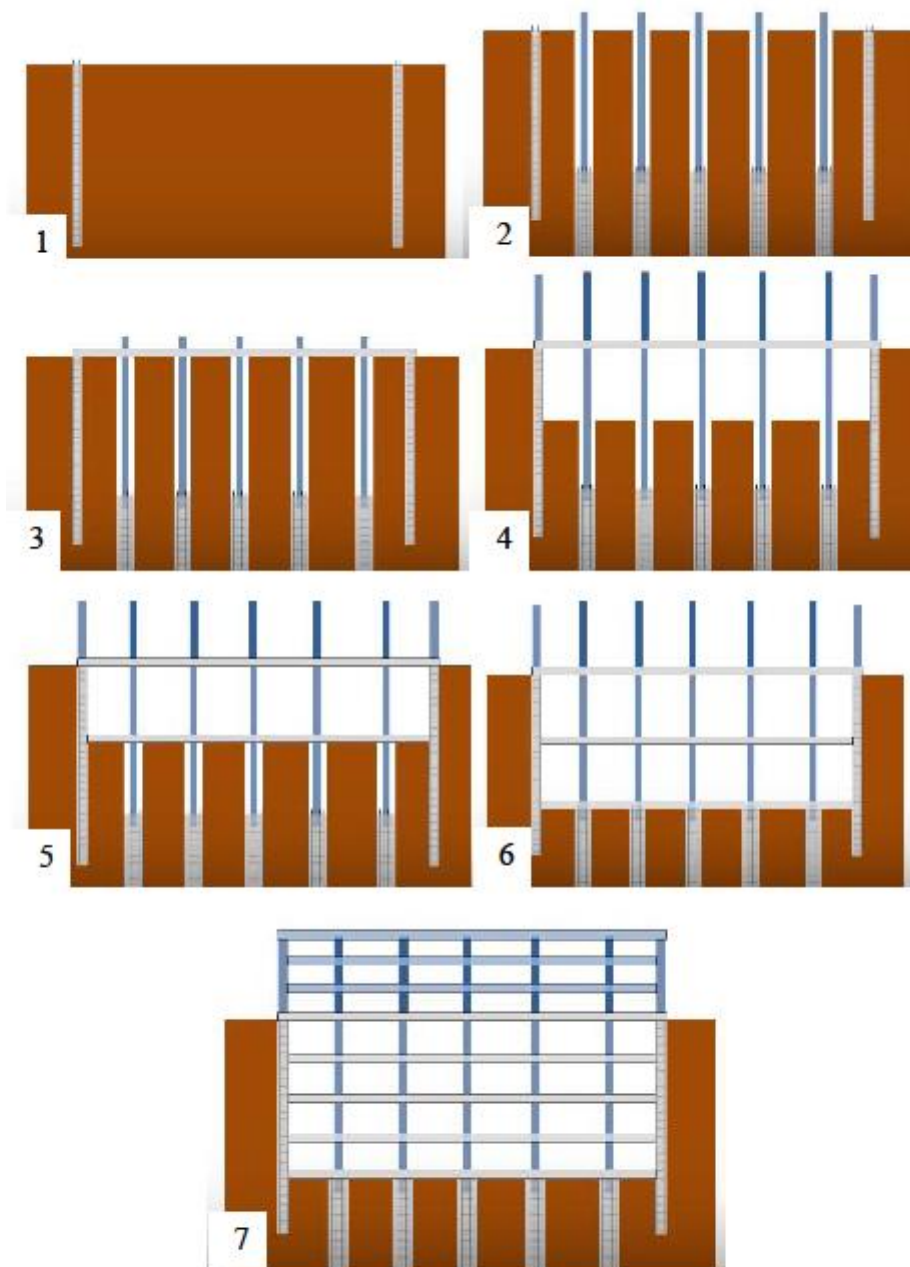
Пример последовательности возведения здания методом «сверху-вниз». 1- устройство «стены в грунте», 2 – производство свай и подземных частей колонн, 3 – устройство перекрытия на уровне земли, 4 – разработка первого слоя котлована и наращивание колонн, 5 – устройство подземного перекрытия, 6 – дальнейшая разработка котлована, 7 – устройство конструкций подземных перекрытий и надземной части.
